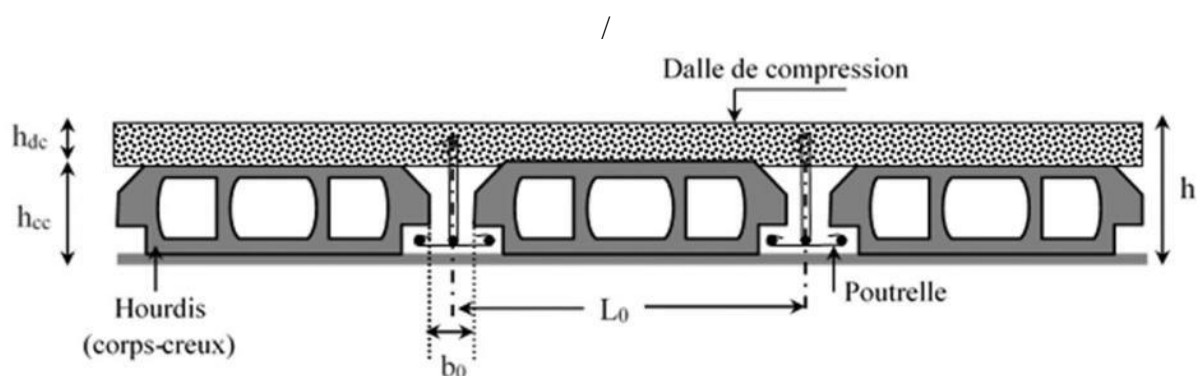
Coupe transversale d'un plancher à corps creux .
